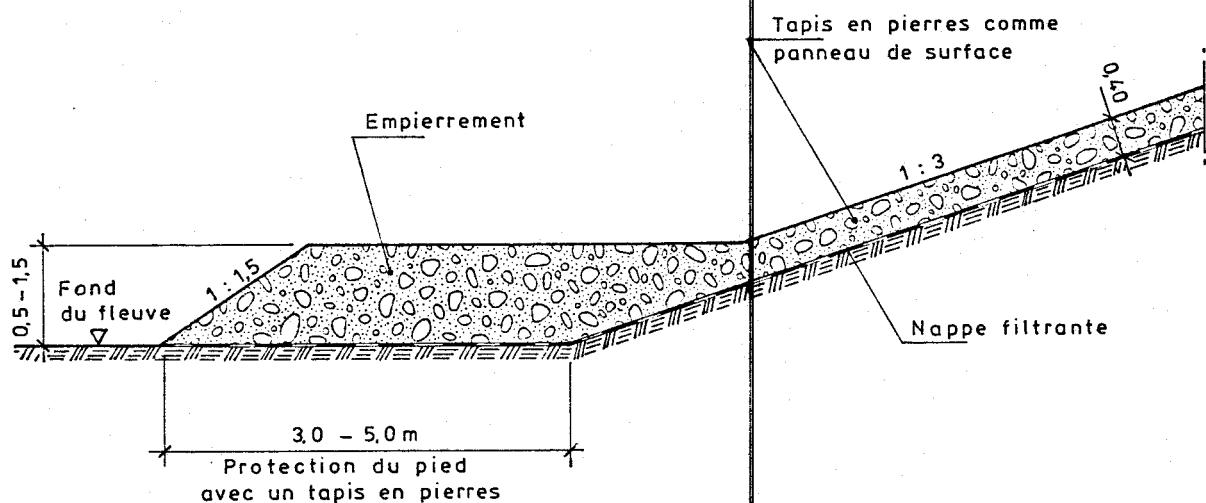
b): Panneaux de surface avec tapis en pierres pour la fixation du pied
